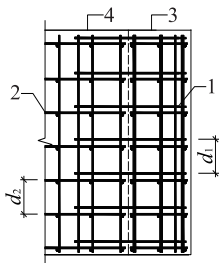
叠合剪力墙水平连接钢筋构造
